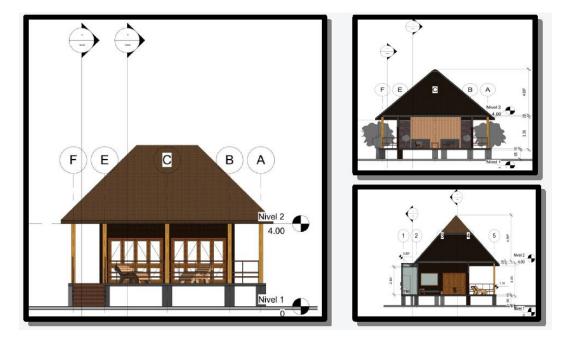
Vista preliminar de las fachadas y tipo de cabañas del Centro Ecoturístico el Madresal
